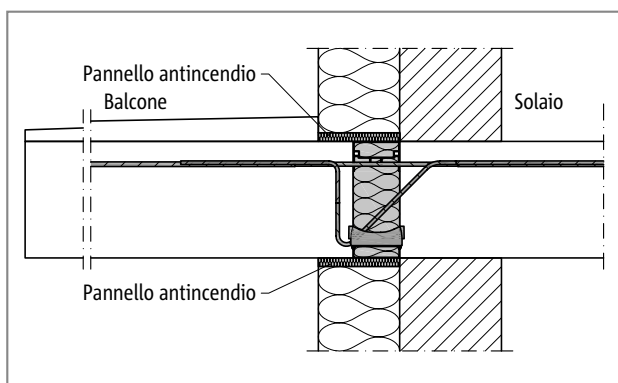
Schöck Isokorb® tipo K: configurazione REI30 nel sistema di isolamento a cappotto con strato isolante minerale
